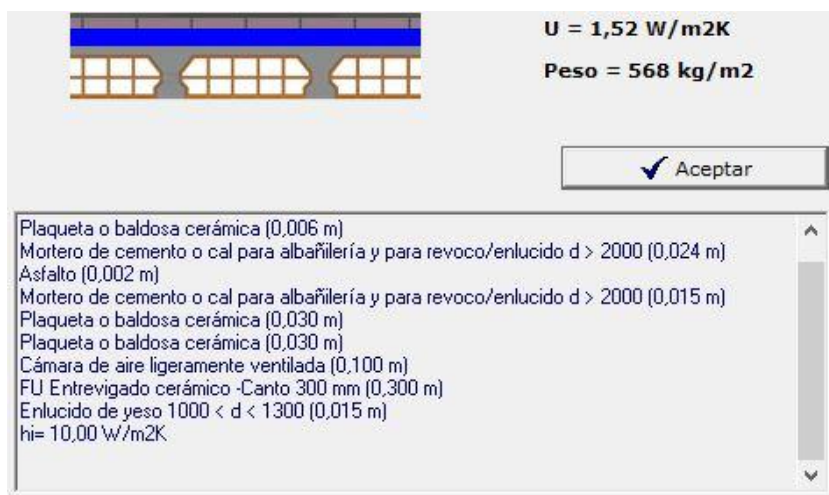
Composición de la cubierta del edificio existente. Fuente: CERMA
